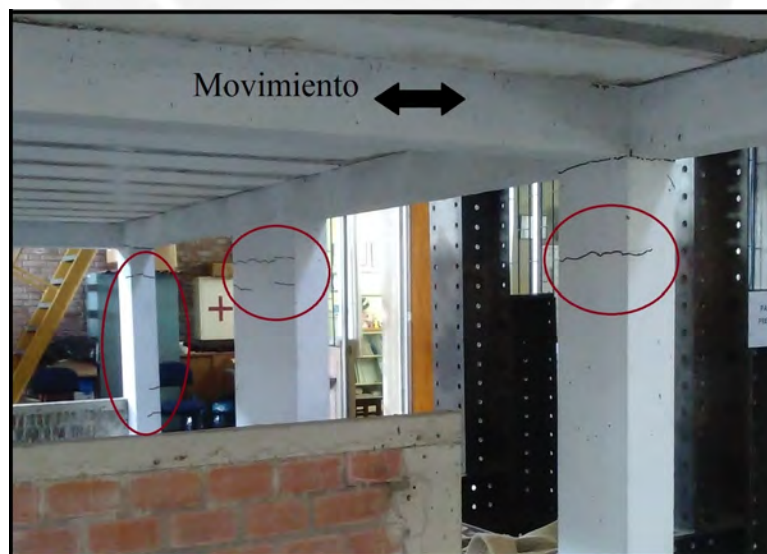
Post Fase 3, fisuras por flexión en las columnas del eje C
